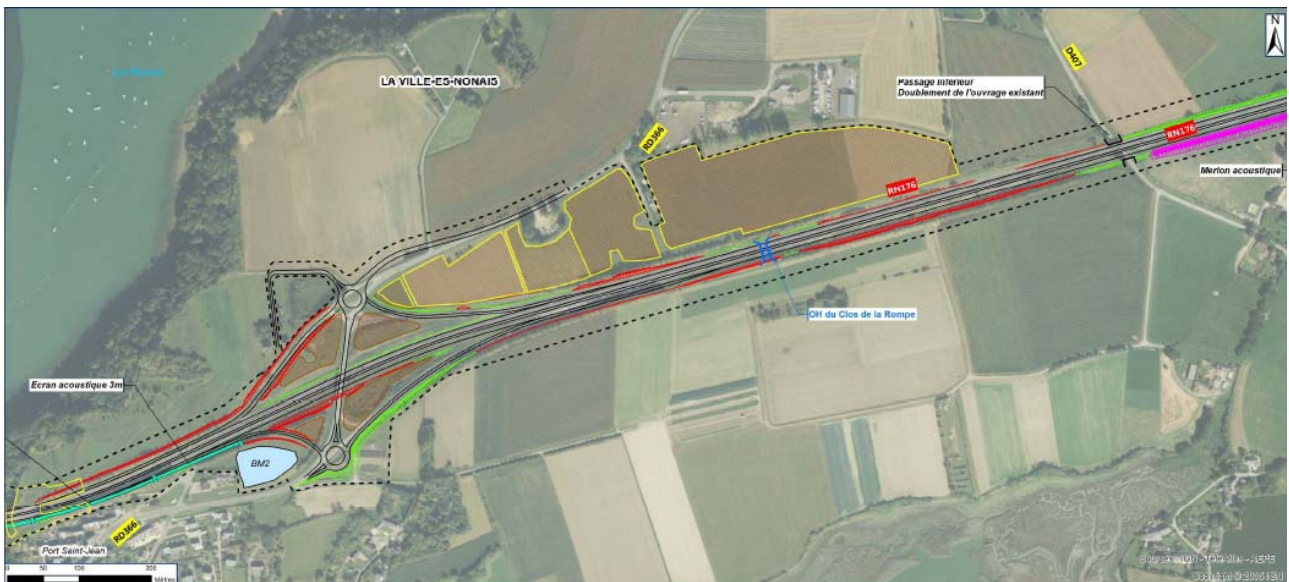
Plan général des travaux au niveau des RD 366 et RD 407 (source : dossier)
